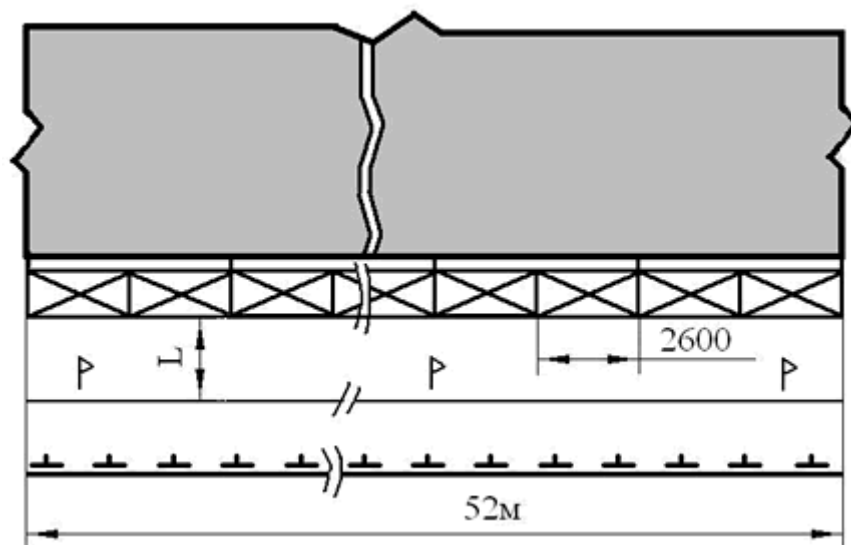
Площадка для монтажных работ (фрагмент) с установкой лесов на захватке
